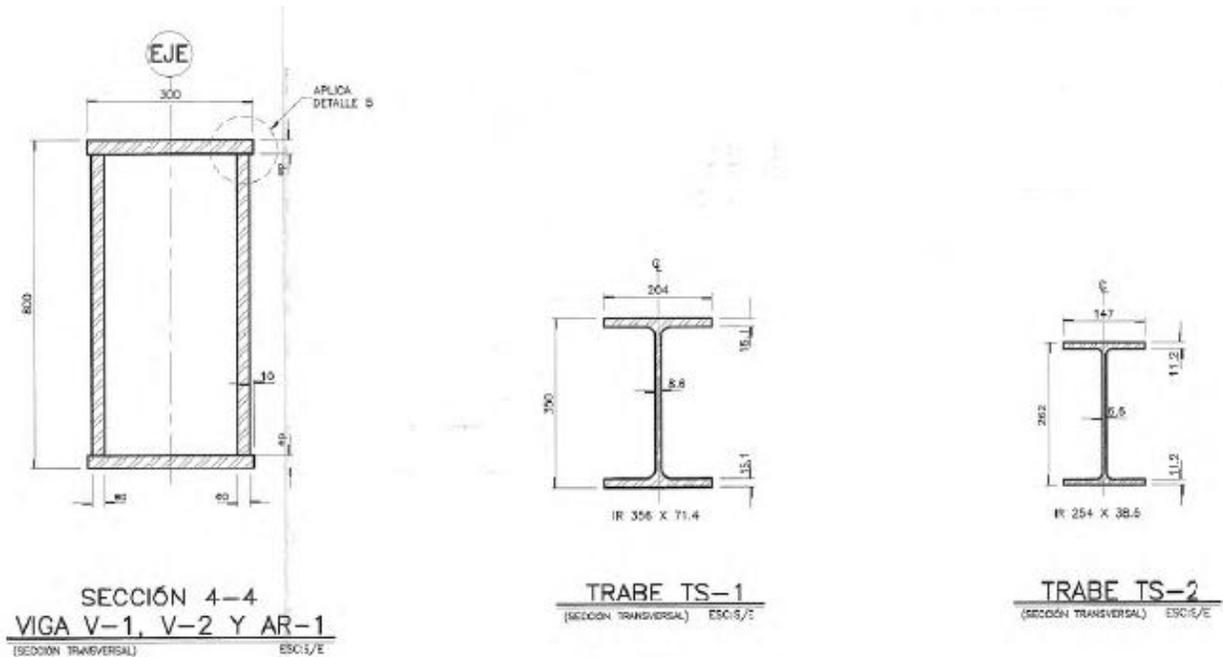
Sección traves tipo cajón principales longitudinales y transversales v-1, v-2, trabe secundarias trasversales perfil IR TS-1 y Trabe TS-2
